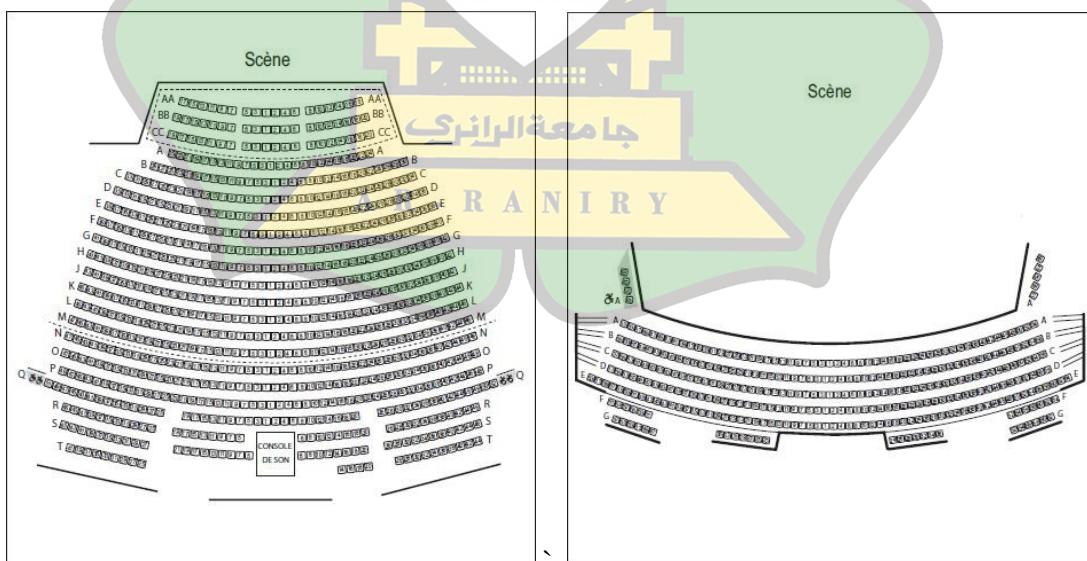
Gambar Denah Théâtre Maisonneuve
